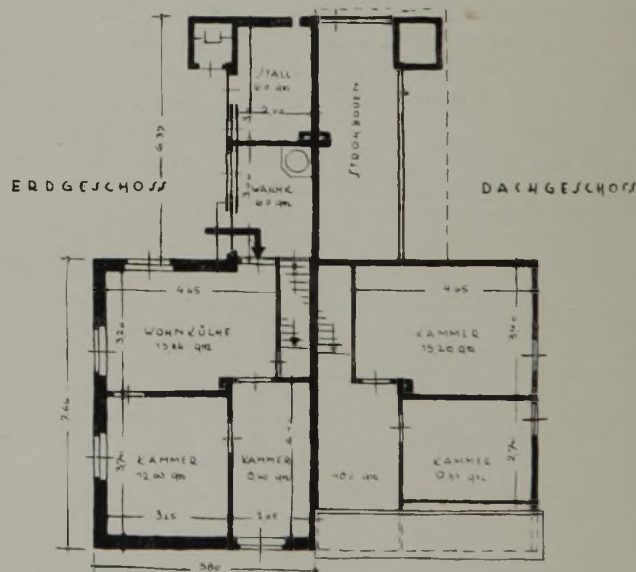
Stadtrandsiedlung Hildesheim. Stall ins Haus eingebaut. Angebauter Holzschuppen.
